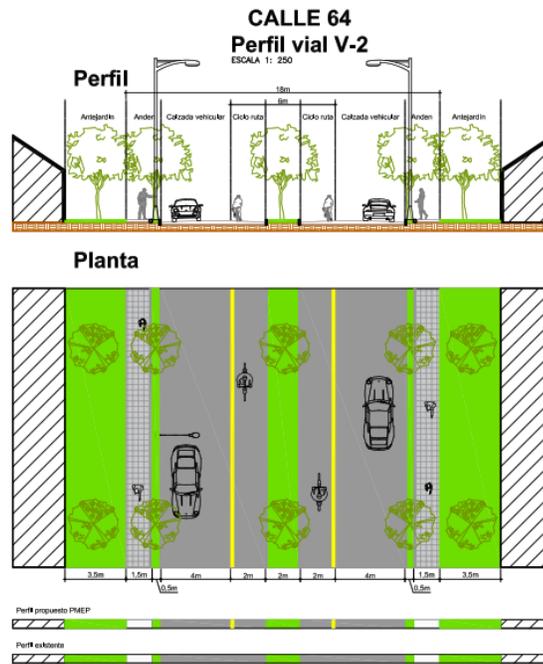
Perfil vial calle 64 V-2. Fuente: Elaboración propia.
